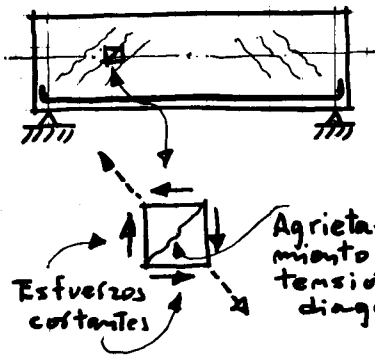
Tensiones diagonales en una viga de concreto, sin refuerzo transversal
